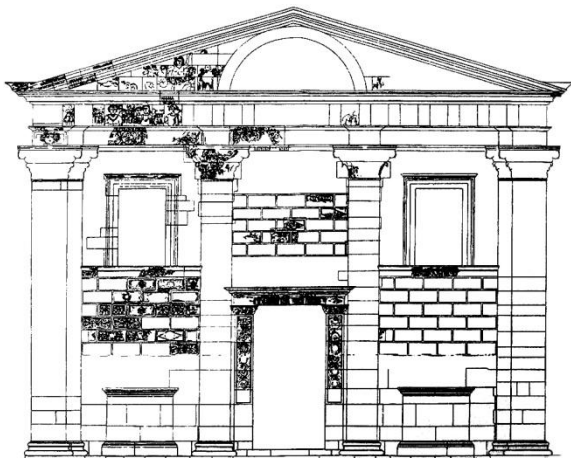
Reconstrucción de la fachada sur del templo de Khirbet adh-Dharih (*Ibid.*, fig. 126).
